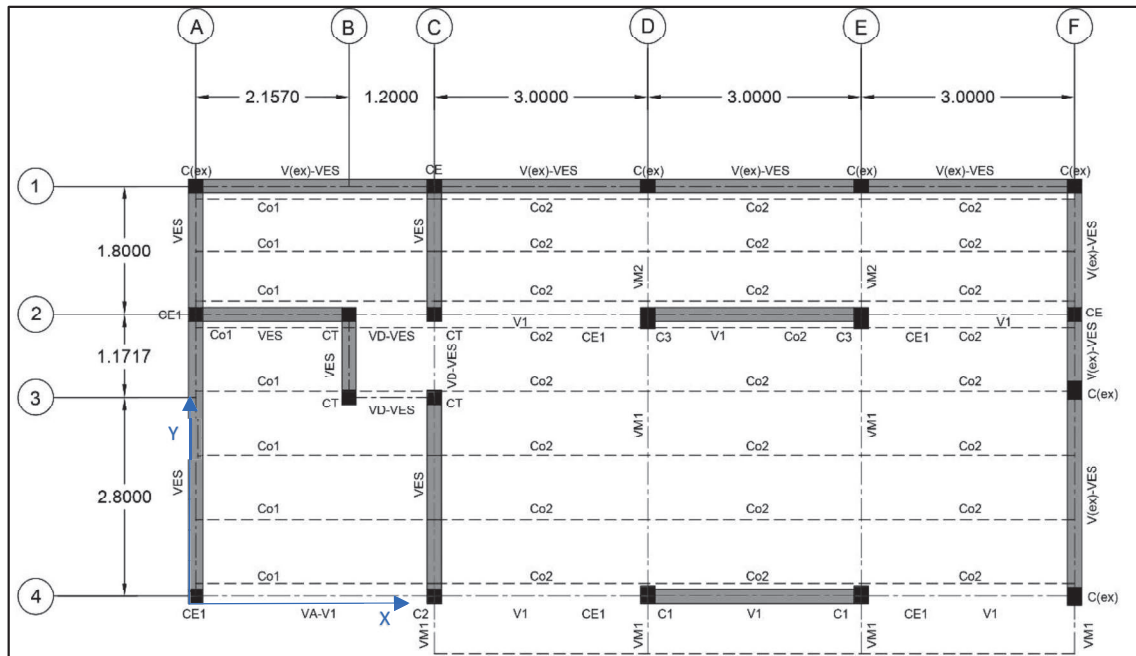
Planta estructural propuesta y ejes utilizados en el análisis sísmico.
